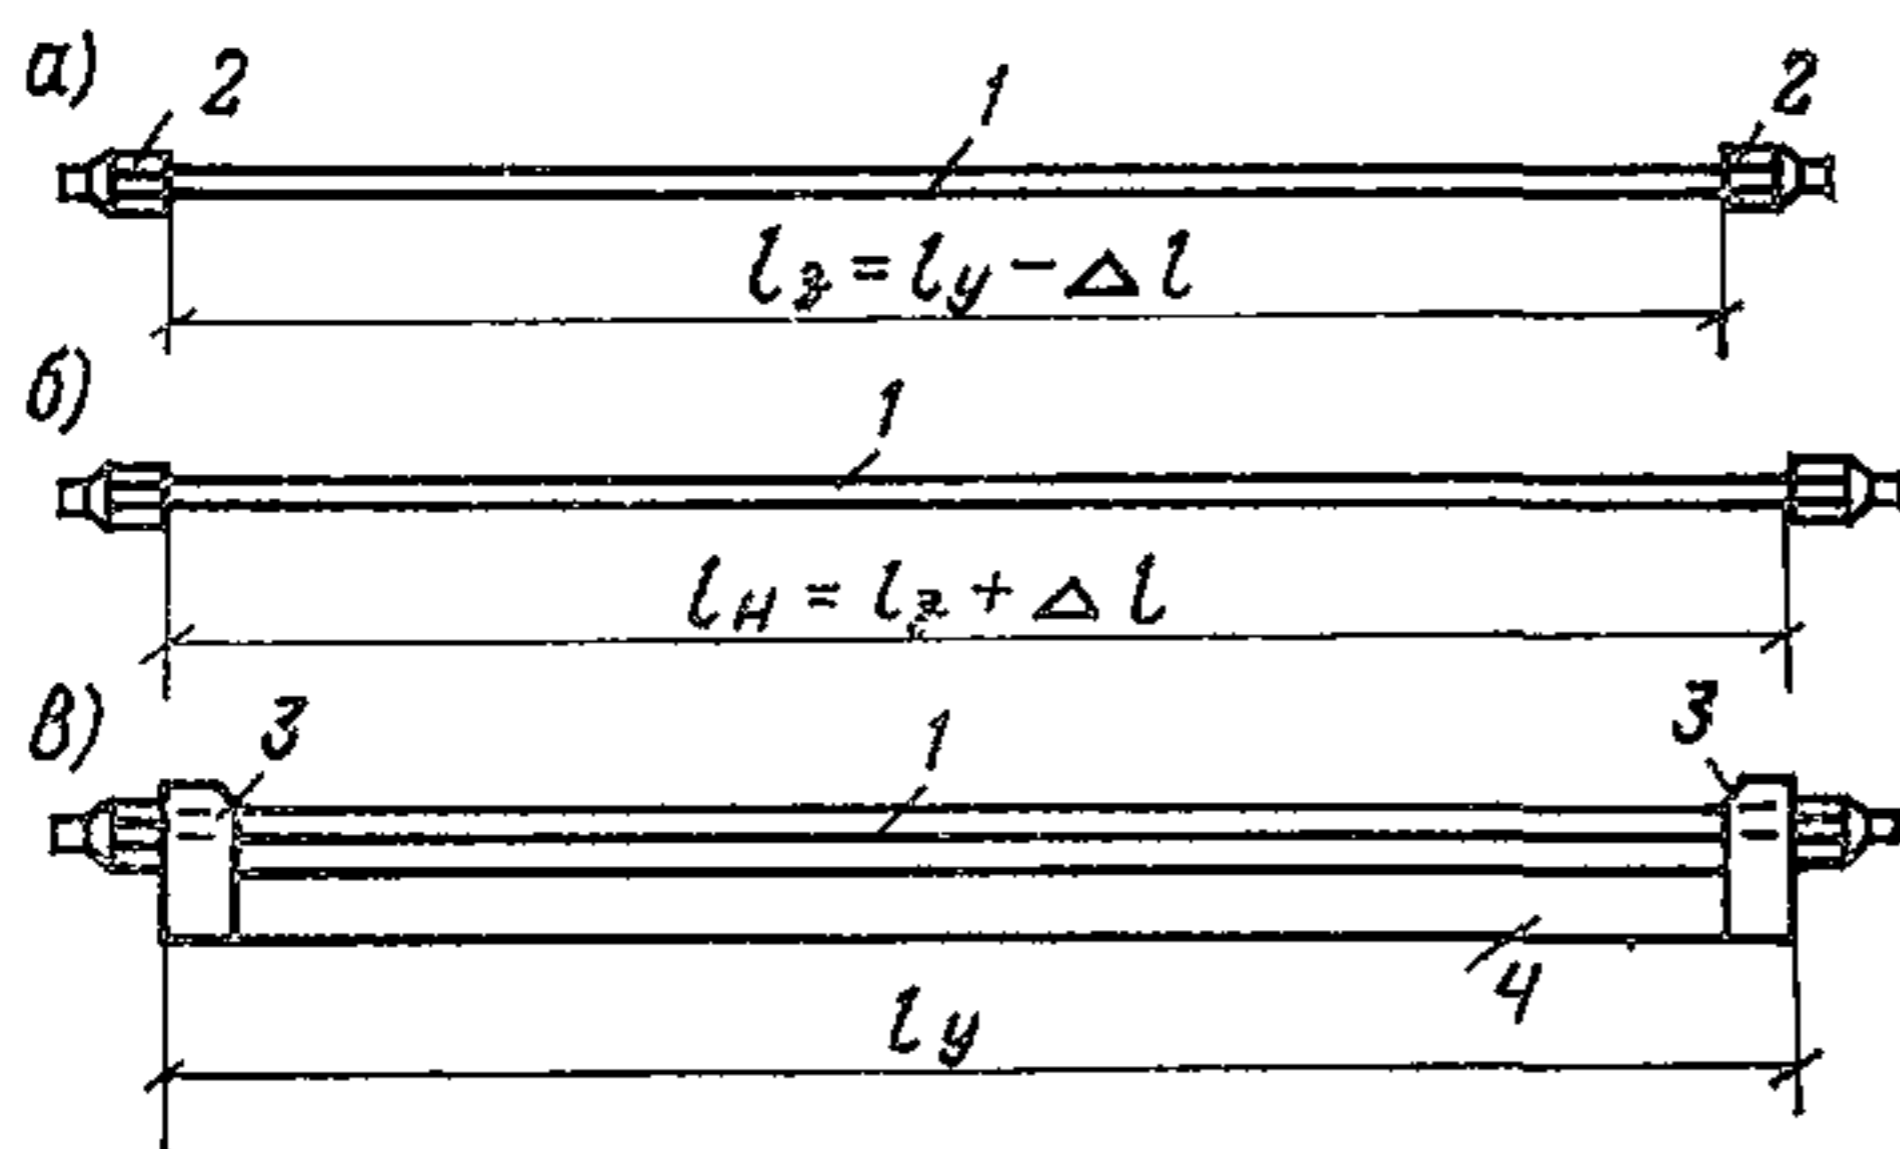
Схема электротермического натяжения арматуры на упоры стенда или силовой формы (поддона)
